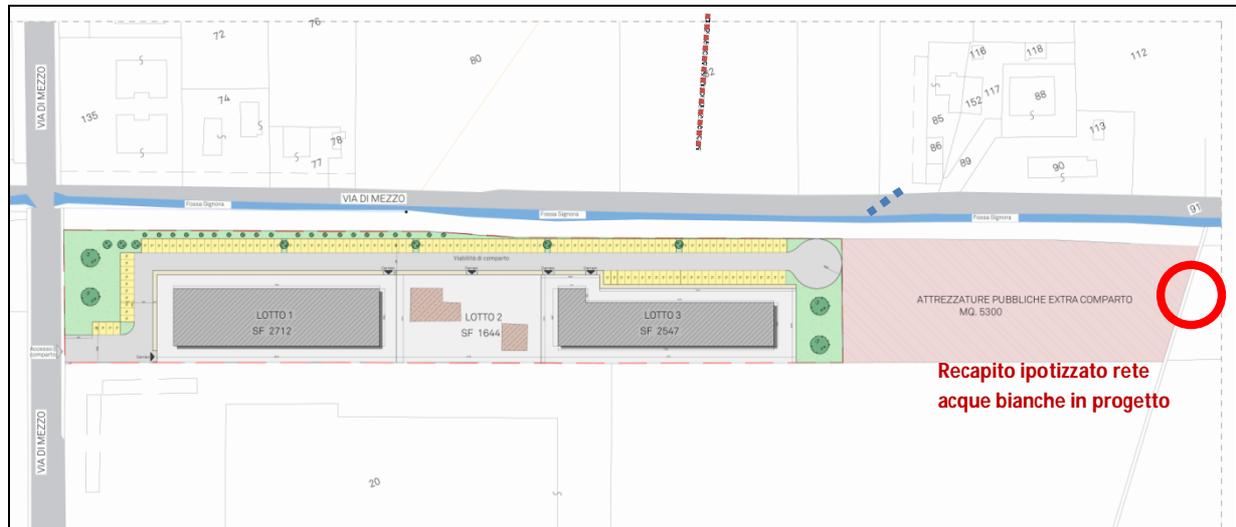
Schema di assetto planivolumetrico della zona in studio.
